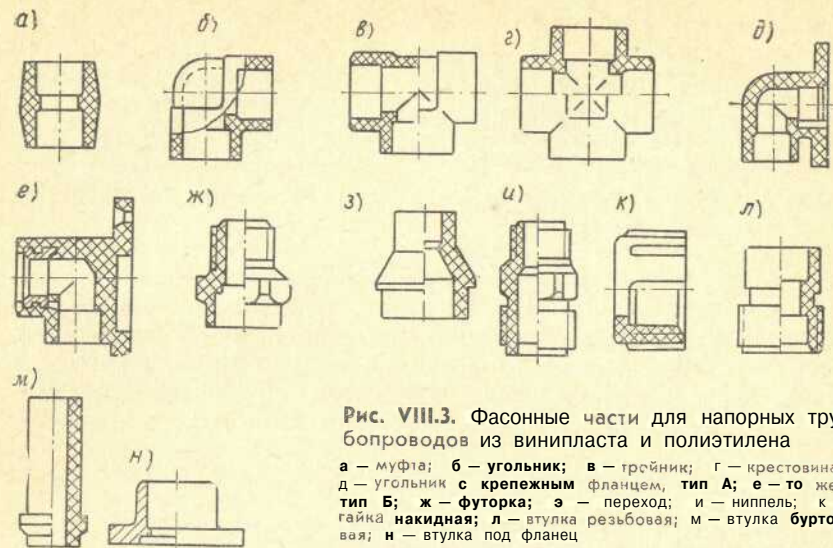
Фасонные части для напорных трубопроводов из винилпаста и полиэтилена
